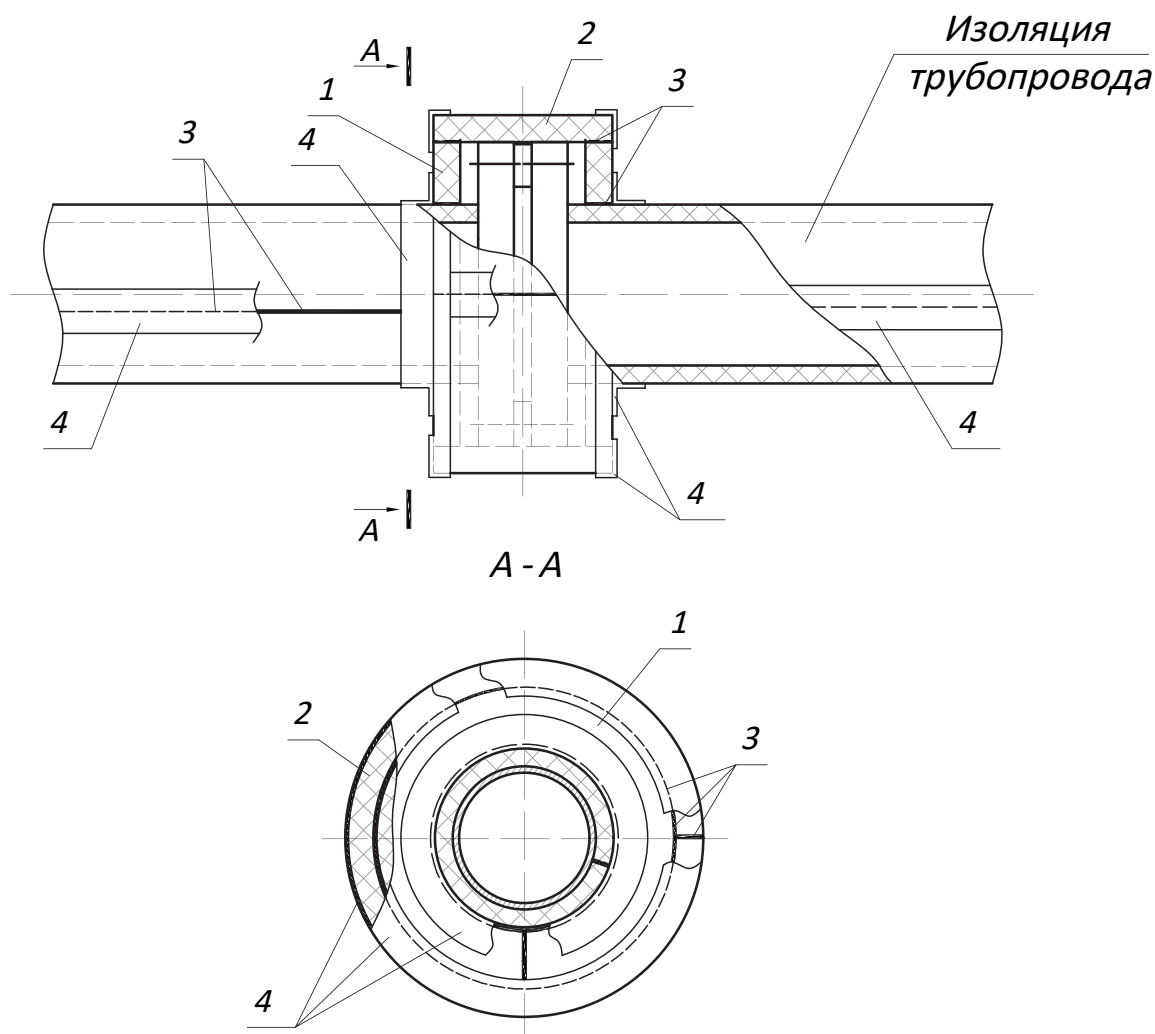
Несъемная тепловая изоляция муфтовой и приварной арматуры трубками AEROFLEX без покрытий или с покрытиями Metal Pro, FG, FG Alu.
